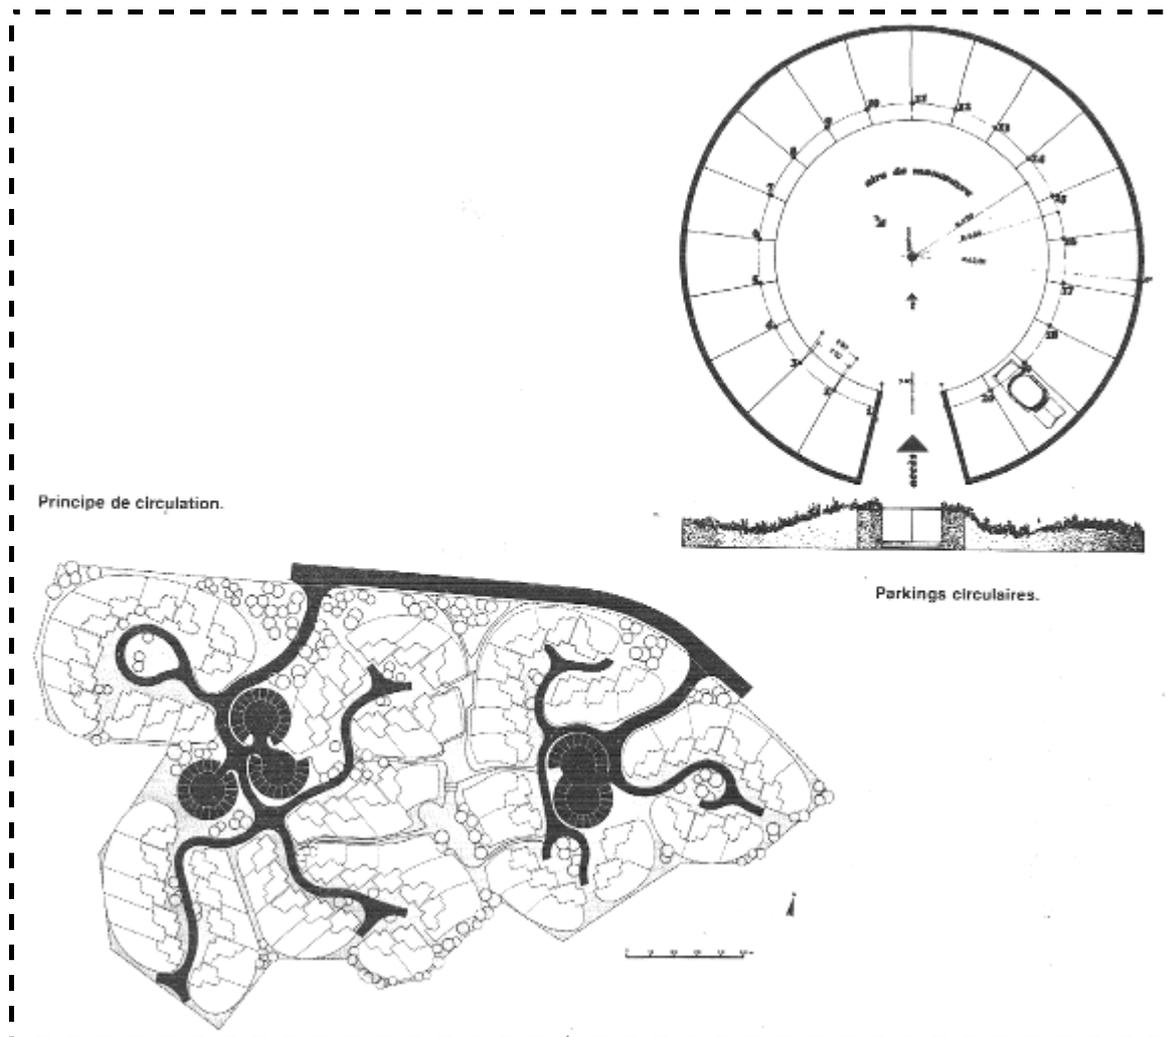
plan de masse de la cité montrant l'emplacement des garages et le détail de celui-ci.
